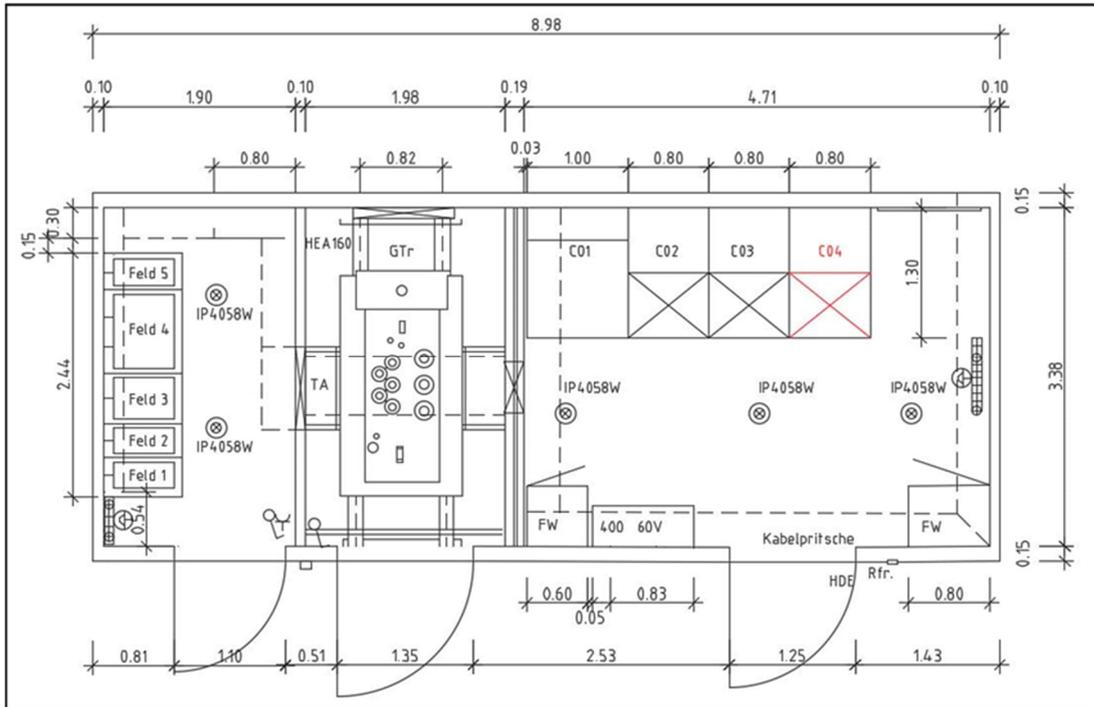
Grundriss G UW Ludwigshöhstraße 120a
